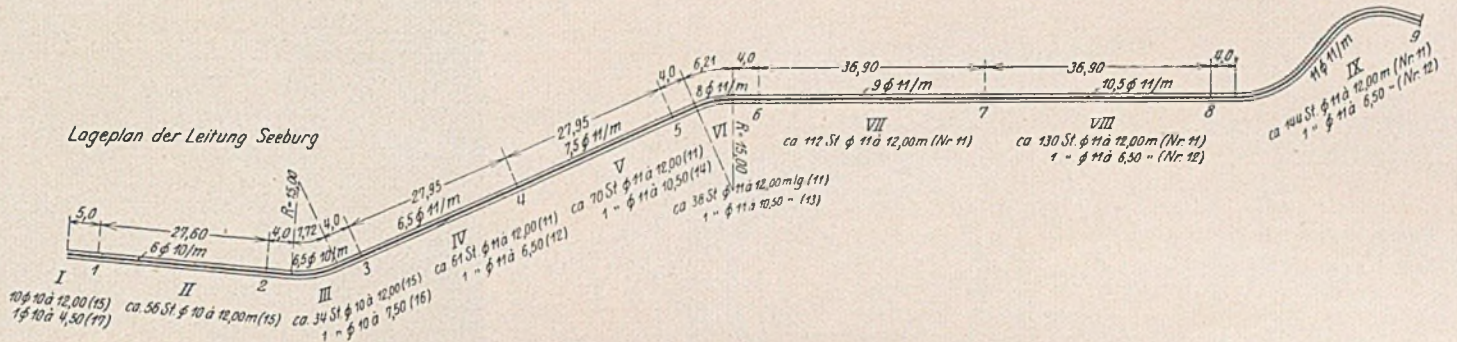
a. Eisenwirtschaftsplan Druckrohr Seeburg, oberer Bauteil.
